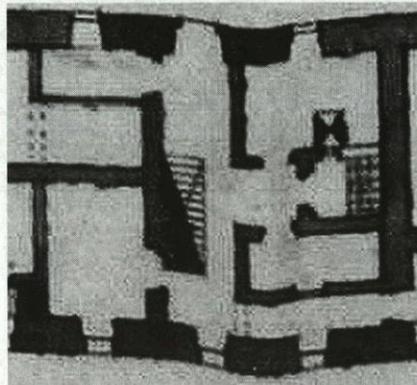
Obermünsterplatz 3, Erdgeschoss vor 1766 (Münchner Plan).
